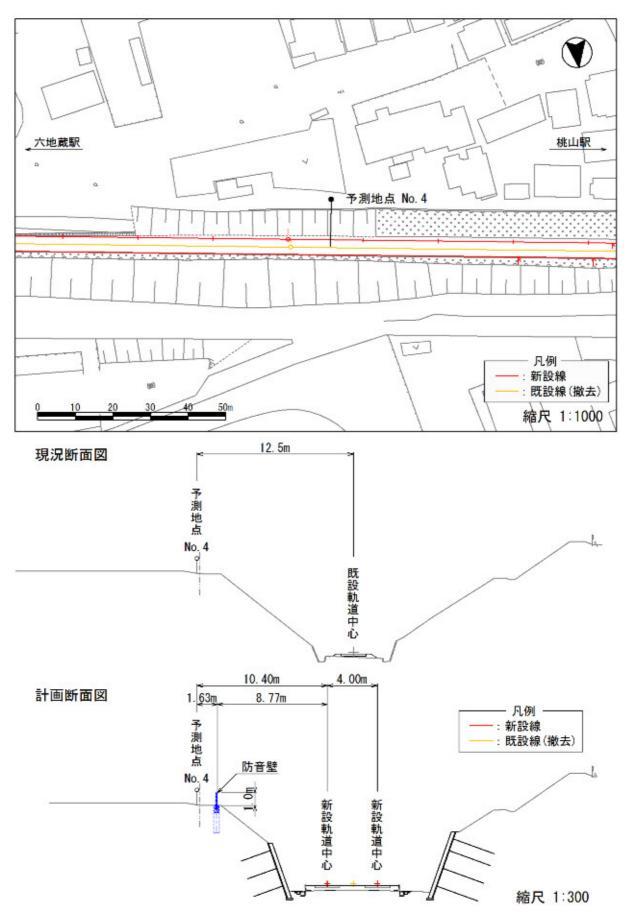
(4) 予測平面・断面図(予測地点 No.4)
